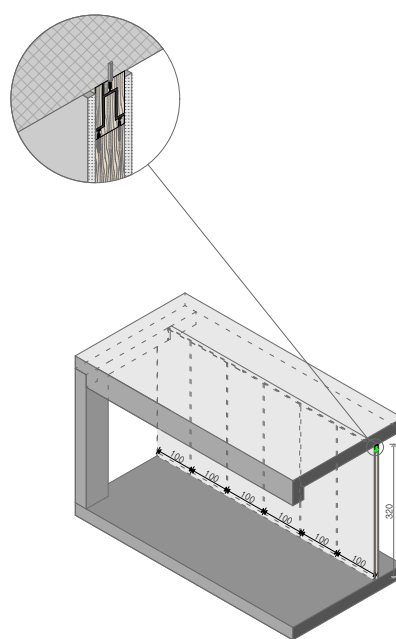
Geometria del muro a graticcio. Immagine elaborata dall'autore.
